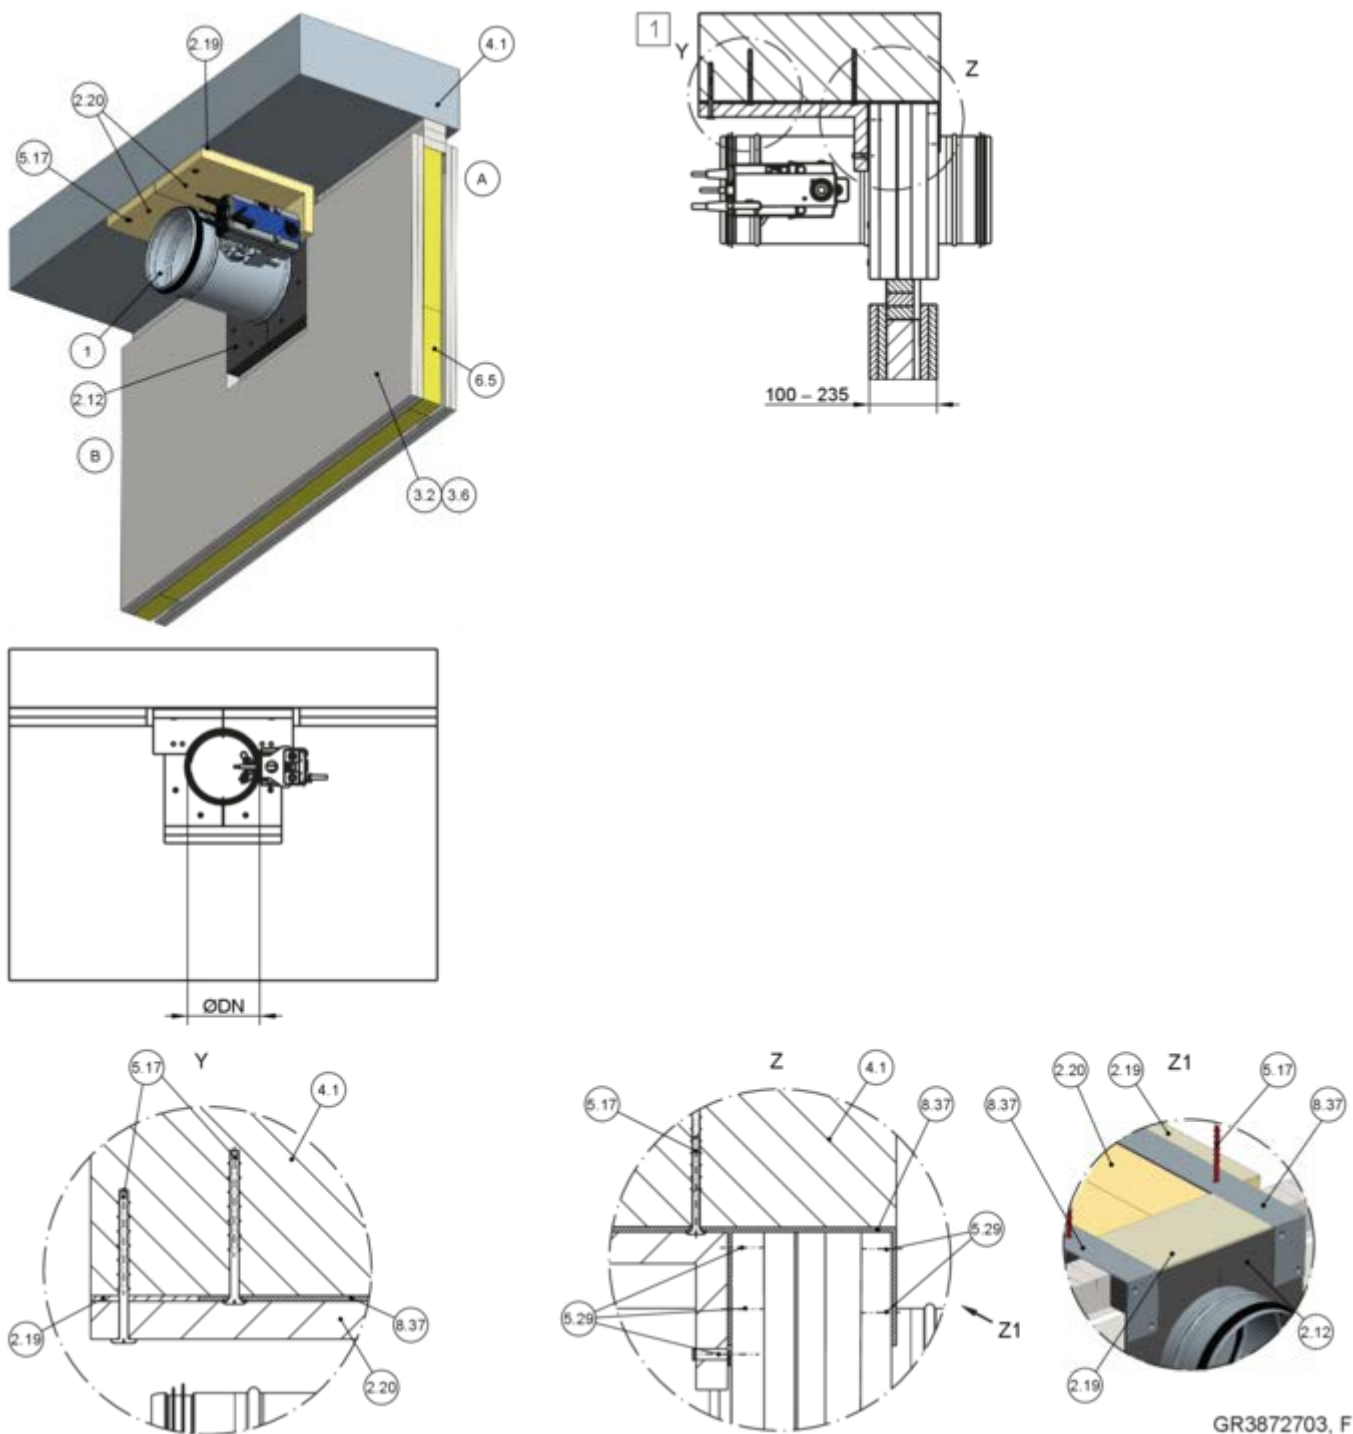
Torr installation utan murbruk i lätt skiljevägg med installationskit GL2 och stålfäste om det inte finns något bakre infästnings alternativ
